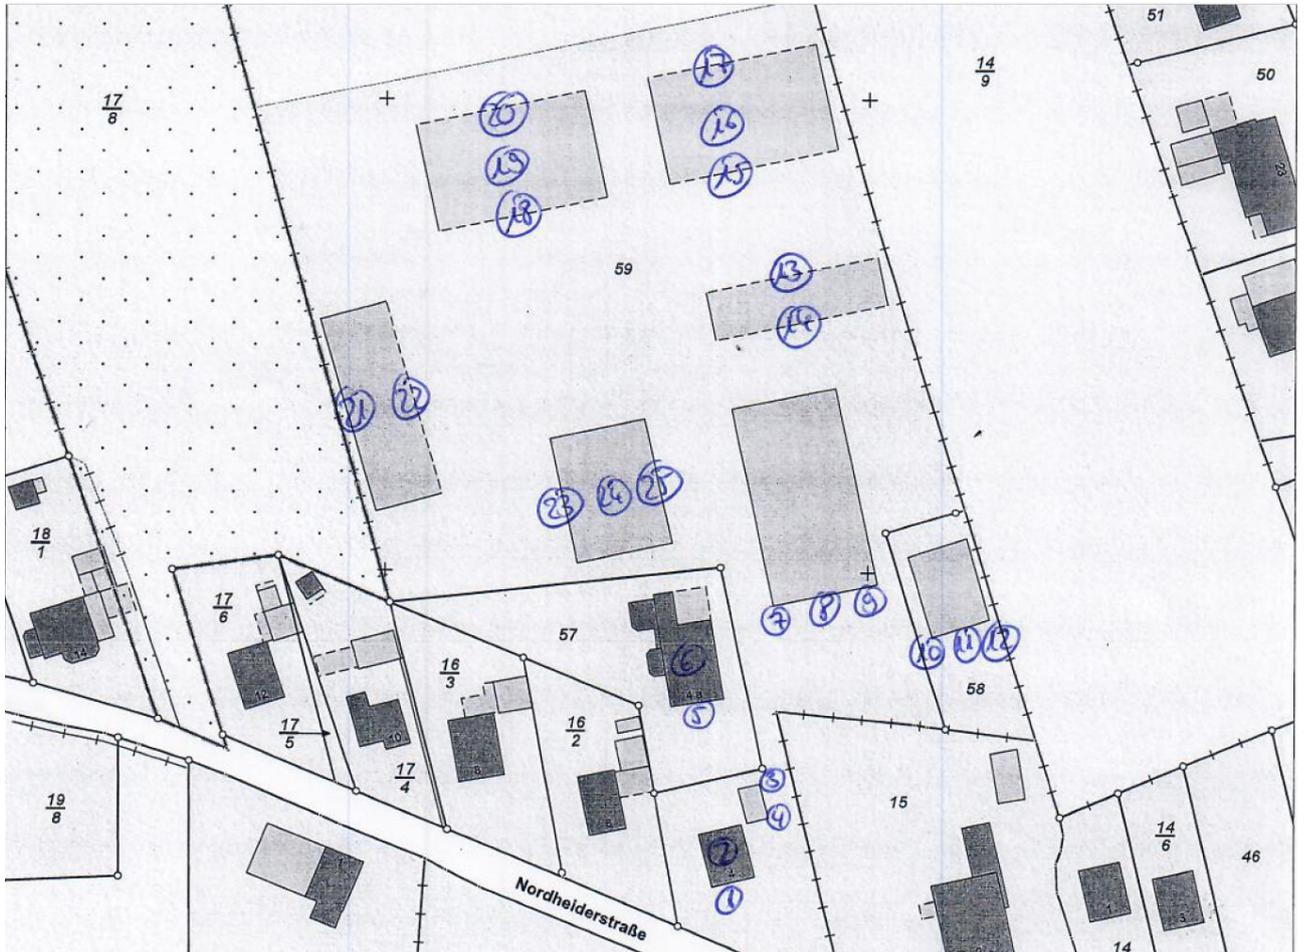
Lageplan des Betriebsgrundstückes von Herrn Tim Blohm mit der Kennzeichnung der Gebäude
